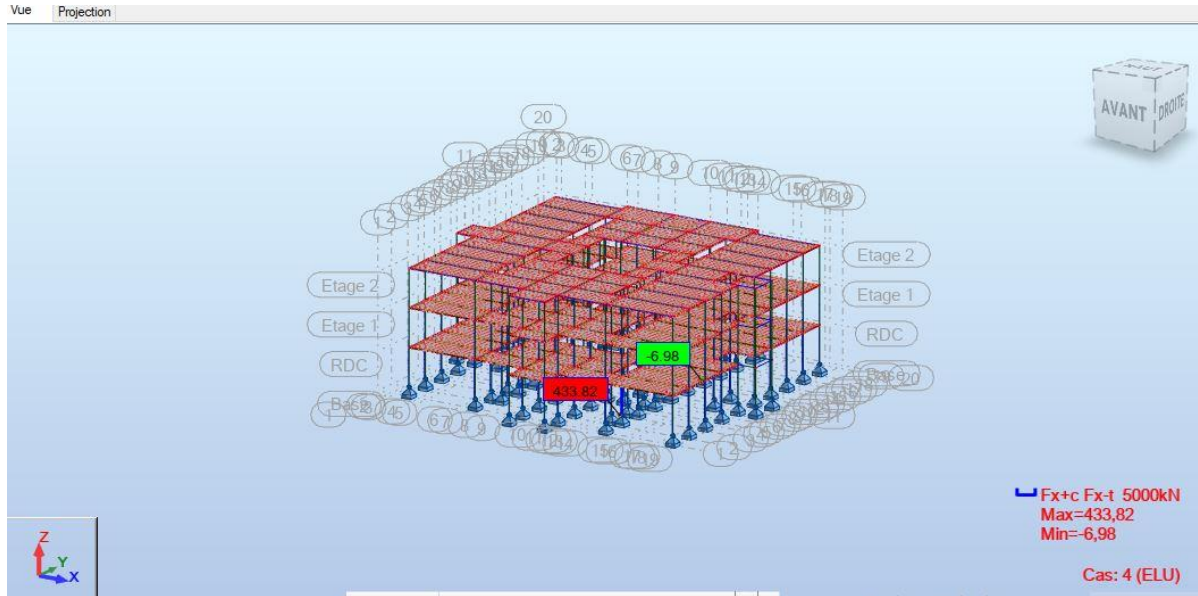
Le poteau le plus chargé de l'ouvrage
